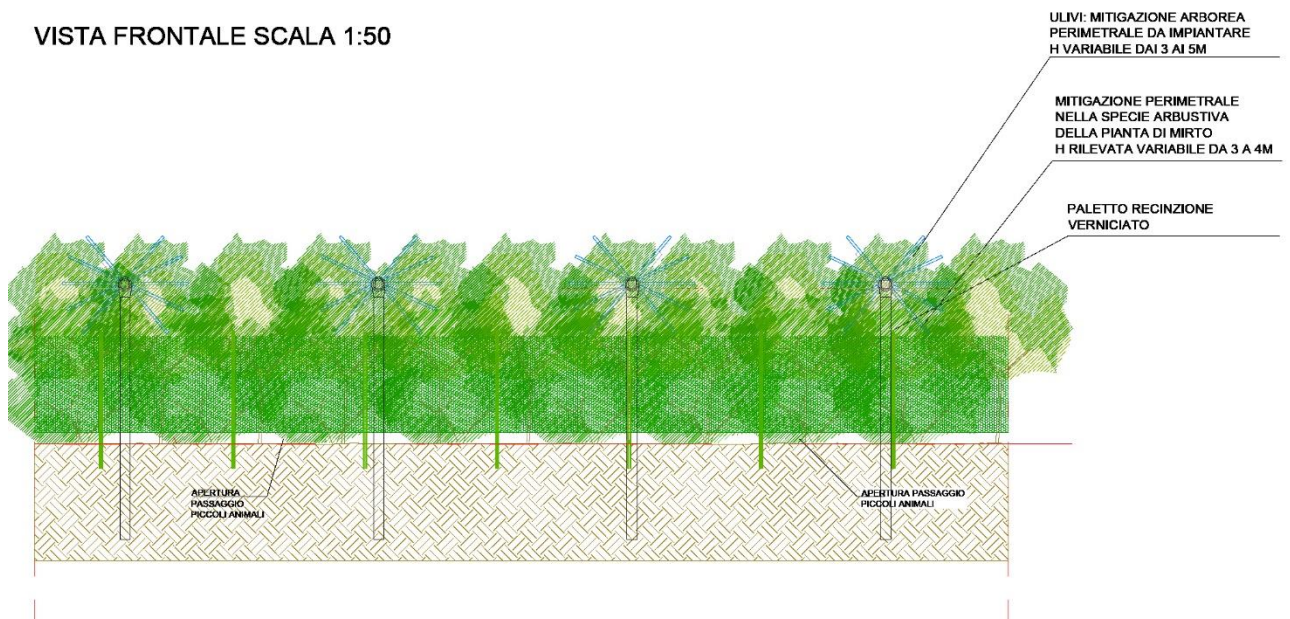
Dettaglio chiusura perimetrale e mitigazione
